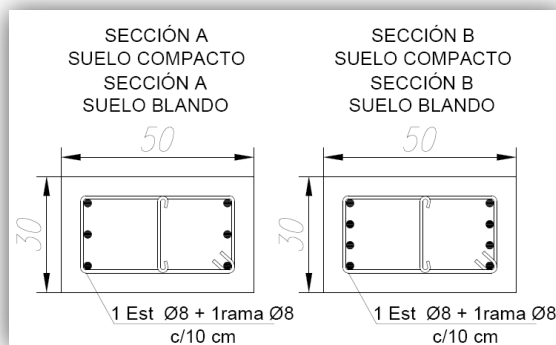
Detalle armadura estribo simple en columna, sección A y B
